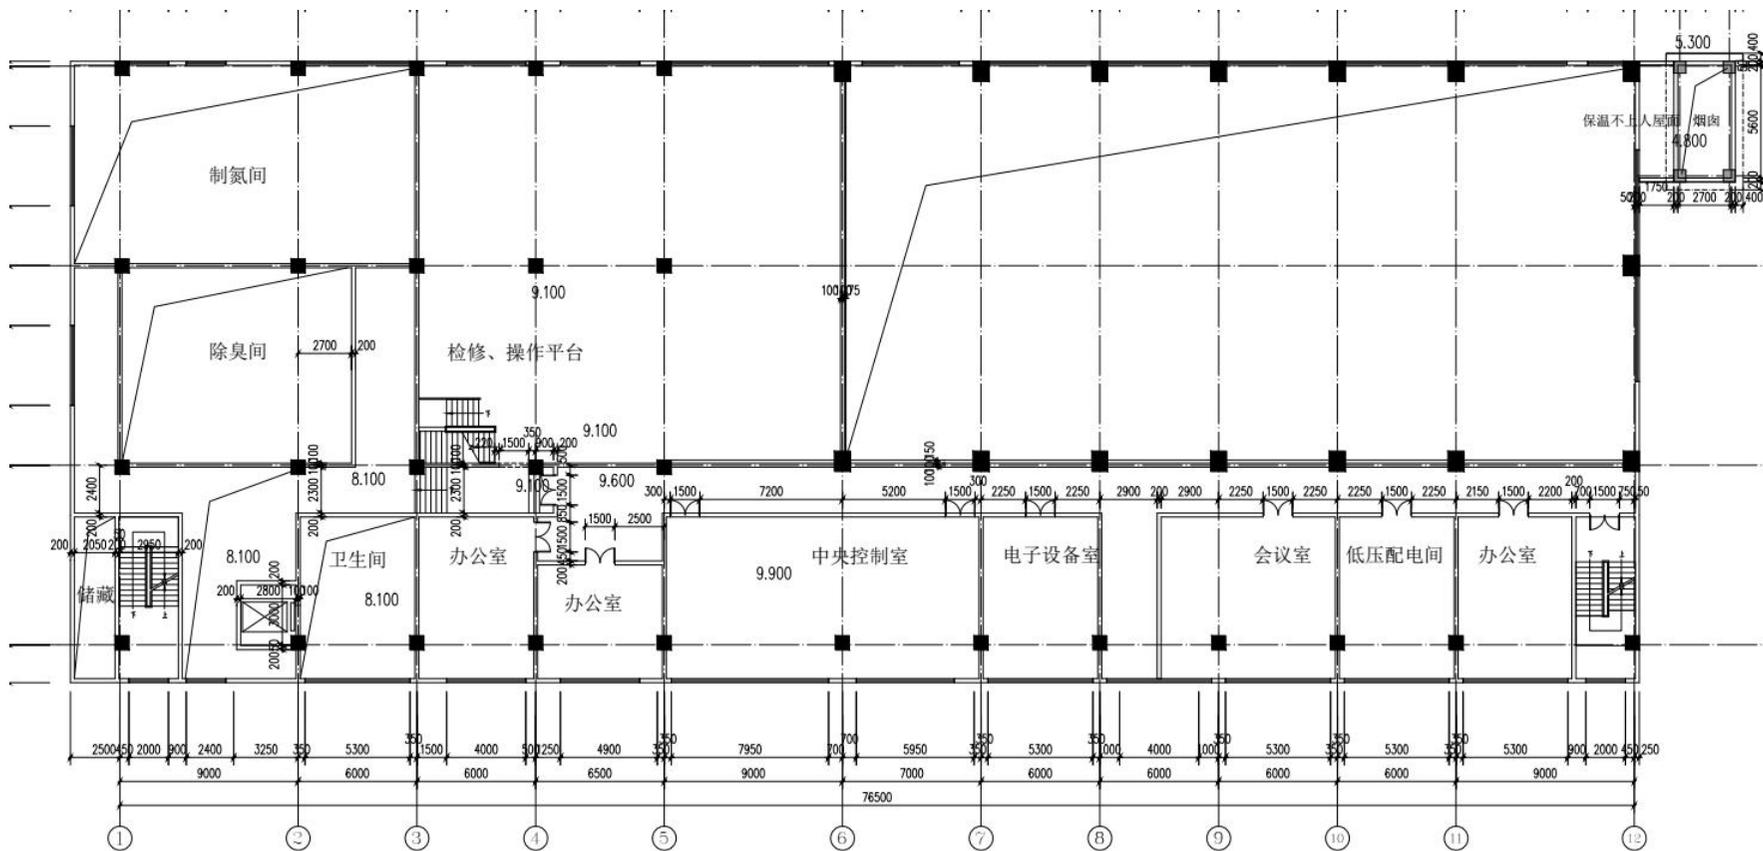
项目主厂房三层平面布置图 (1:150)
